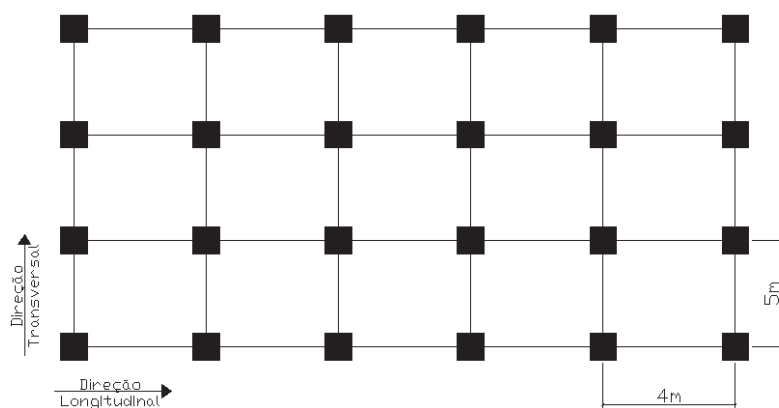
Disposição em planta do PT8 e indicação dos pórticos estudados.
